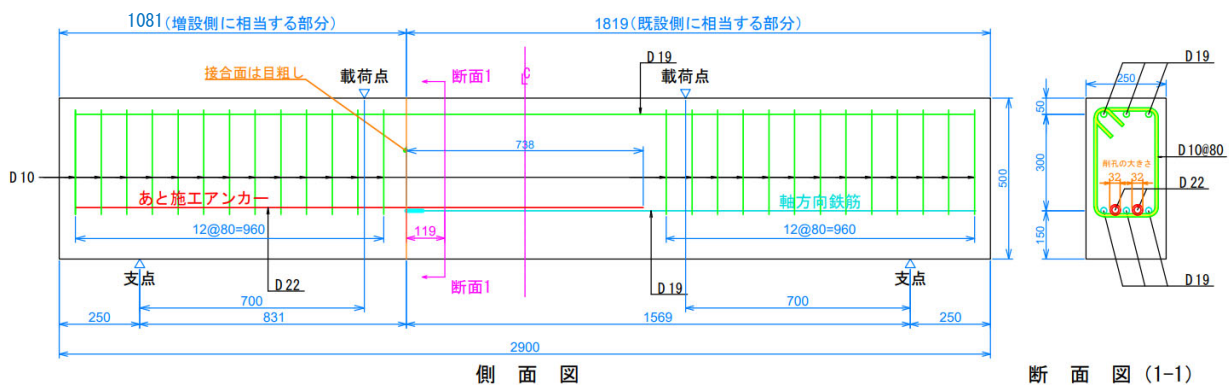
供試体の寸法 (単位 mm) および配筋詳細
